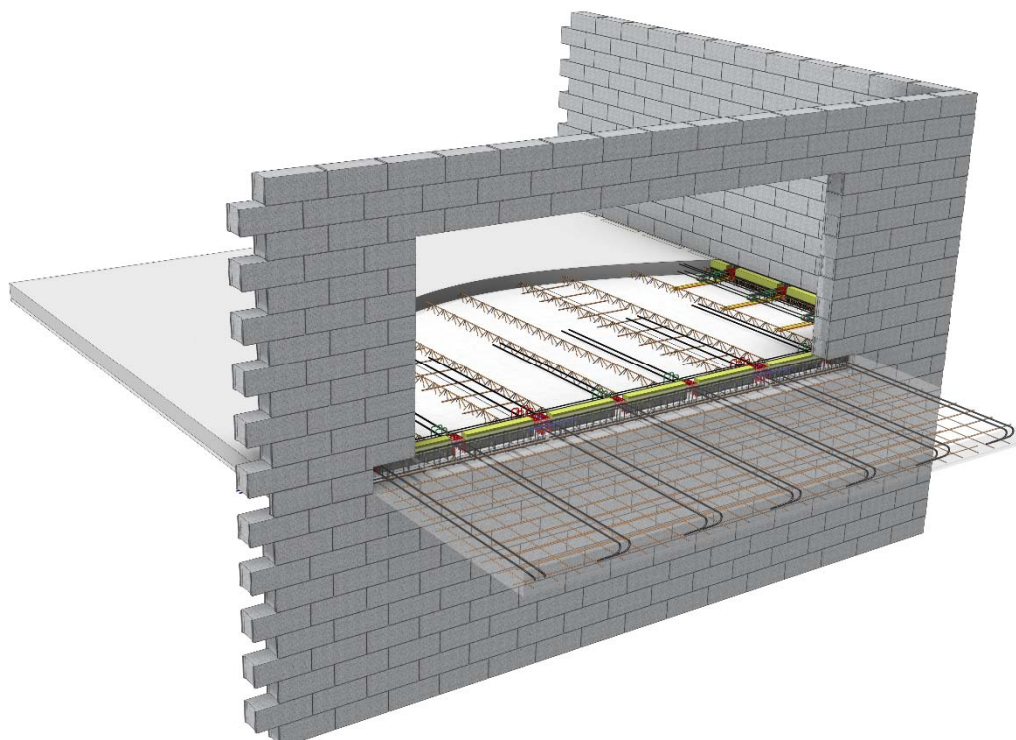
Cas de la prédalle d'angle et d'about - Vue en plan – Coffrage -
